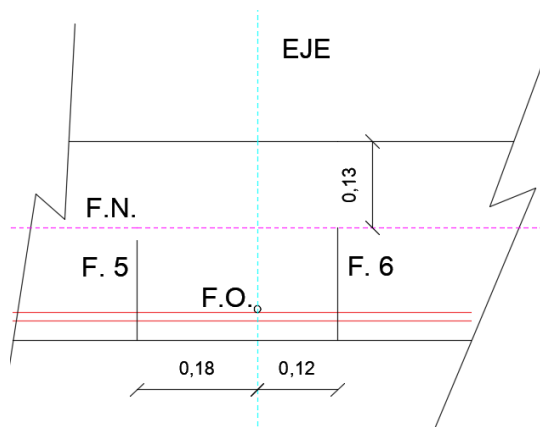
Posición de fisuras y fibra neutra en viga de 200x300 mm.
